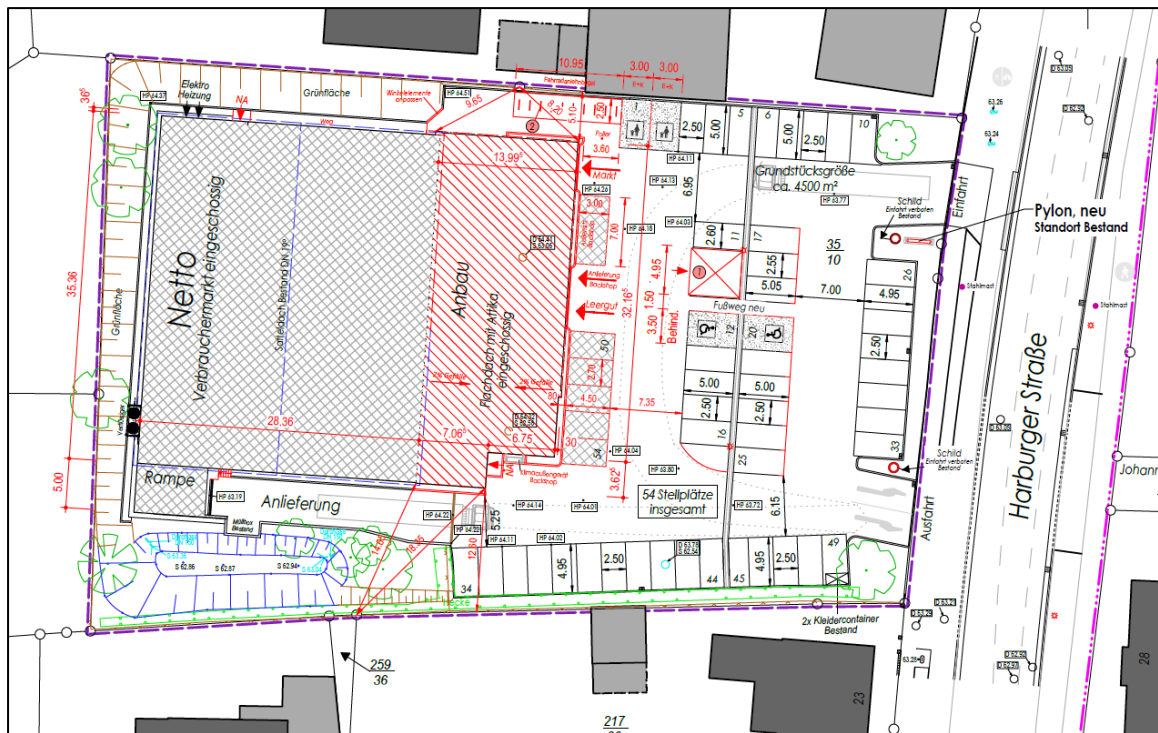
Lageplan An- und Umbau Netto Marken-Discount, Stand September 2025; Quelle: Varius Consulting GmbH
